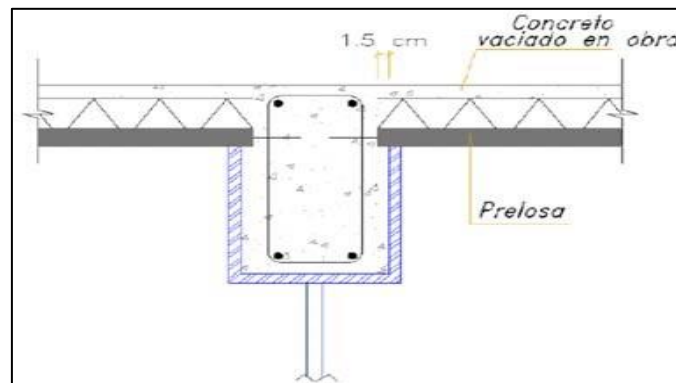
Montaje de 1.5cm de prelosa sobre la cara de la viga. Fuente: Entrepisos
